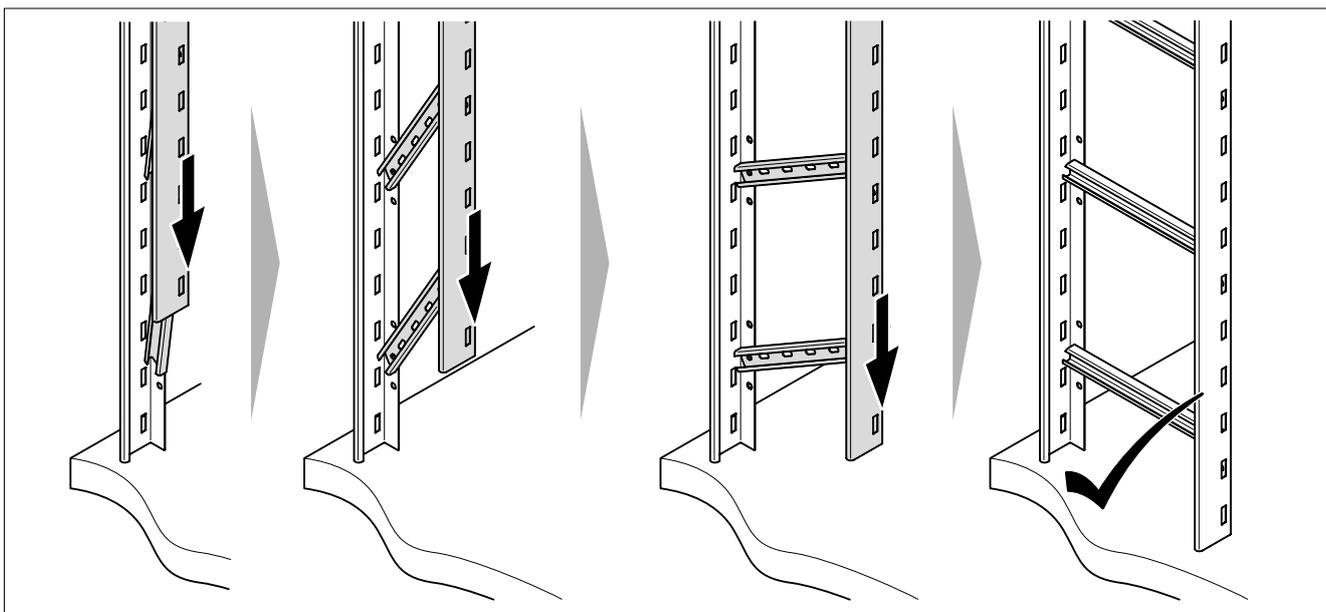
Вертикальное раскрытие кабельного лотка лестничного типа
